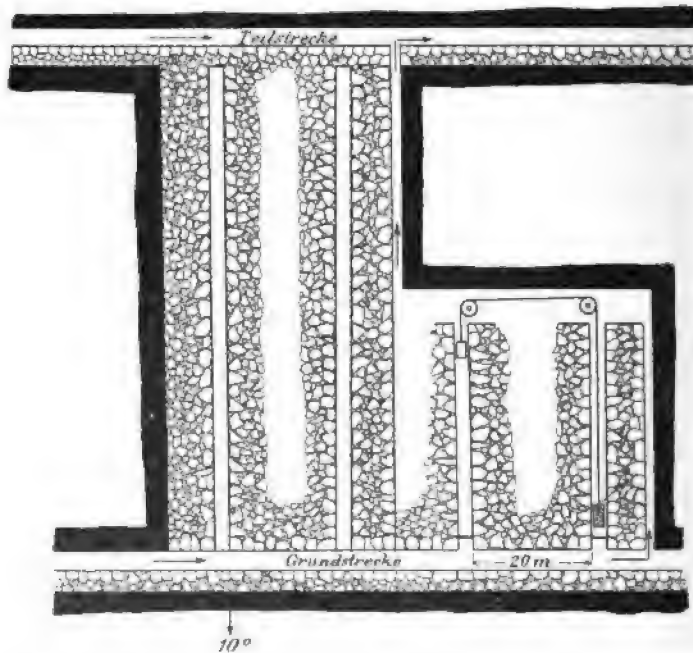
Schwebender Strebbau mit je 2 Förderstrecken für einen Stoß.
